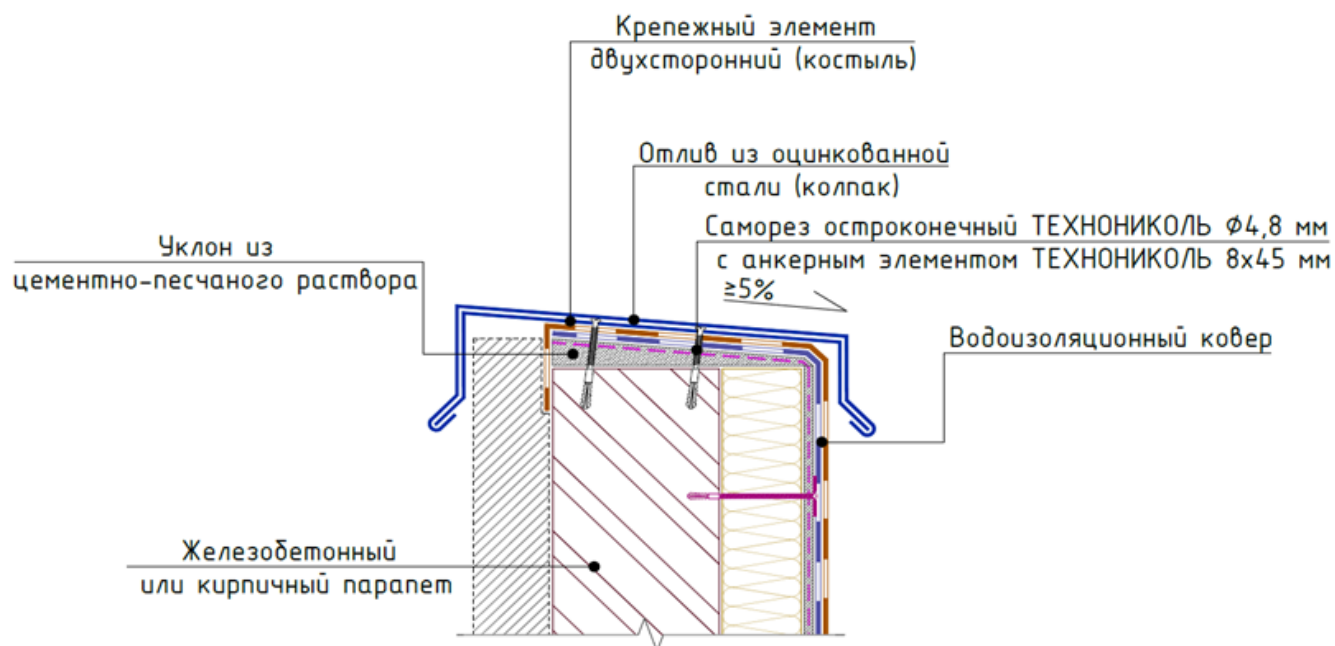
Крепление отлива из оцинкованной стали к верхней части парапета
